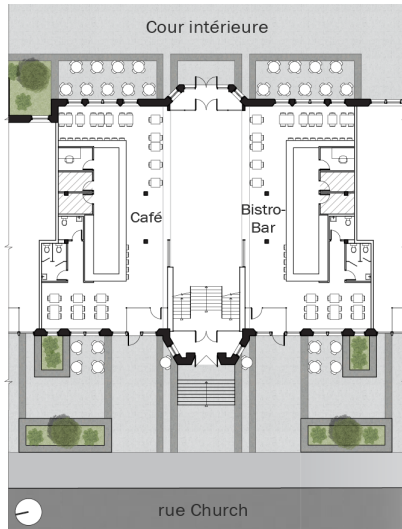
Plan du passage intérieur et des restaurants (voir Annexe II : rez-de-chaussée pour plan complet) (par l'auteure)
